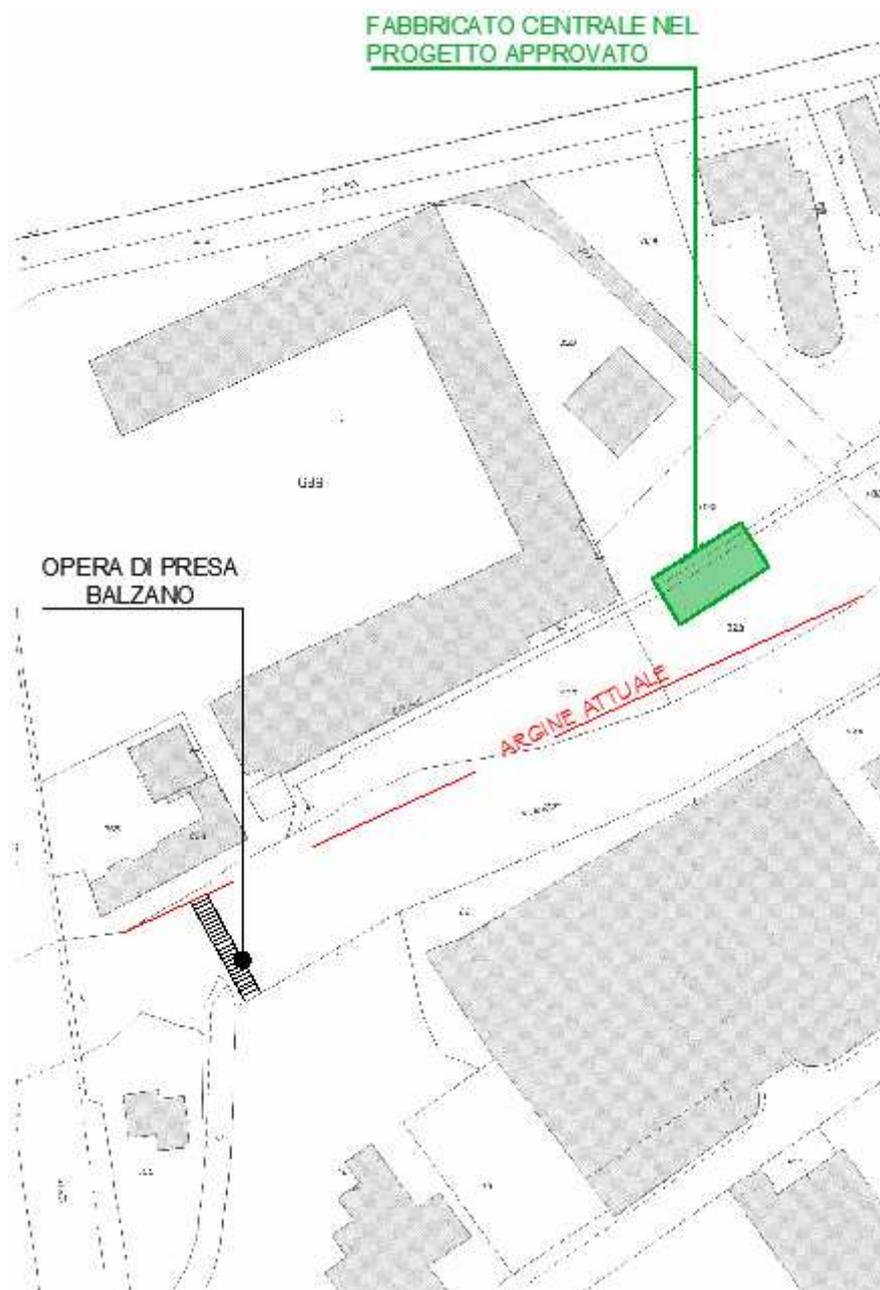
Planimetria catastale area centrale nel progetto autorizzato
